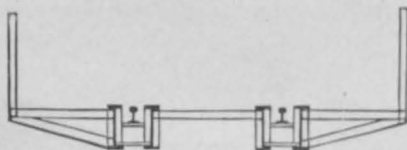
Kleinste Bauhöhe. Schienen unmittelbar auf Querträgern zwischen Zwillings-Hauptträgern. Bahn versenkt.
